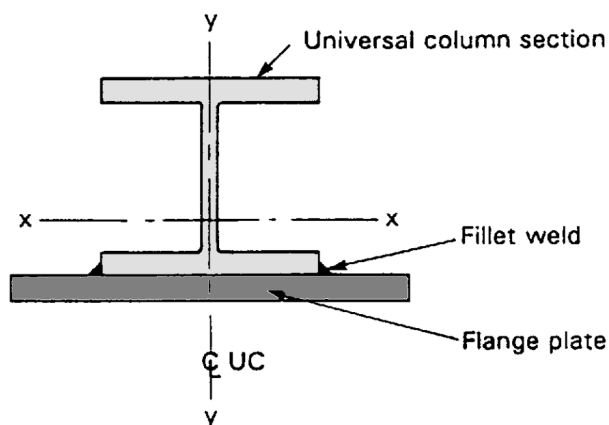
“*Slimfloor*” beam (Mullett, 1992).
